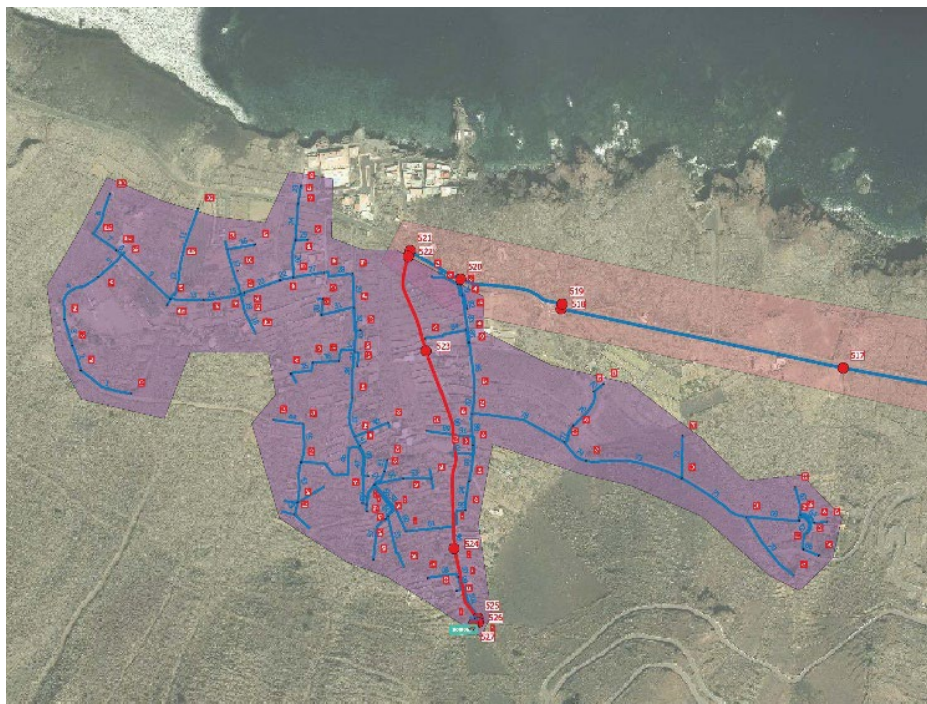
Tramos de conducción nuevos y ya existentes. Detalle
